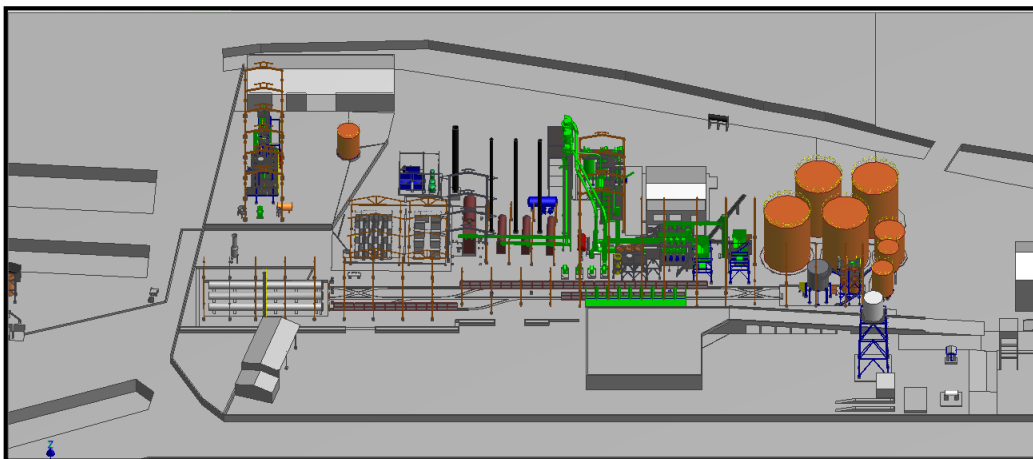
modelo planta extracción de aceite de palma, fuente autor
